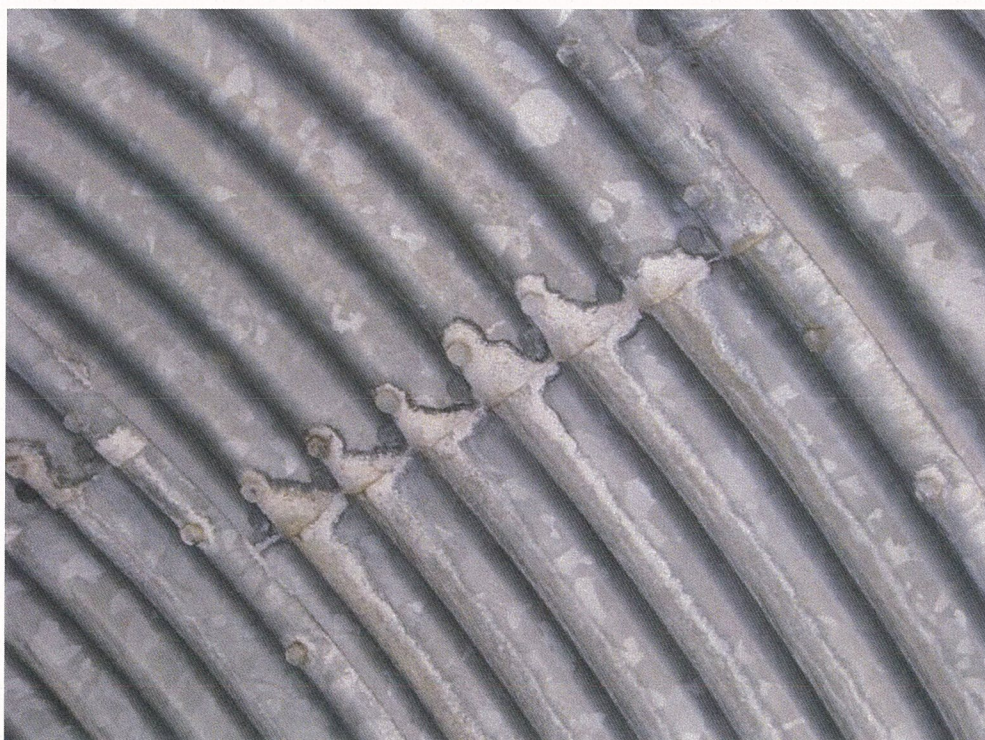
Traces blanchâtres (oxyde de zinc) situées en clé au profil 12 m.
